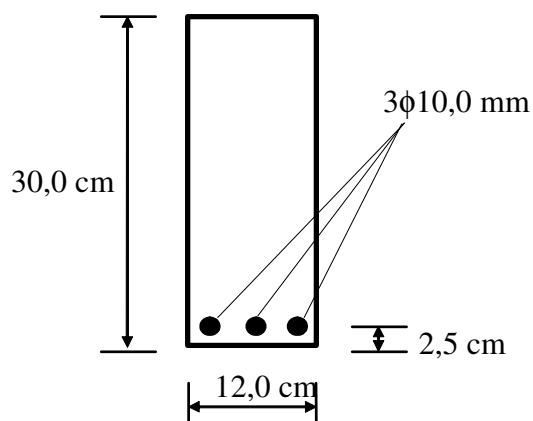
Seção transversal da viga: disposição da armadura principal
